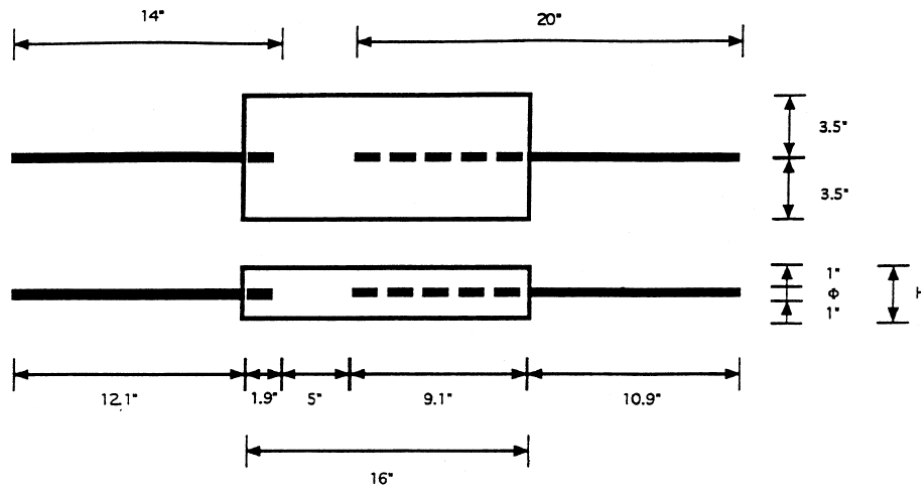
Schema vzorků a rozložení zkoušky dle [80]
